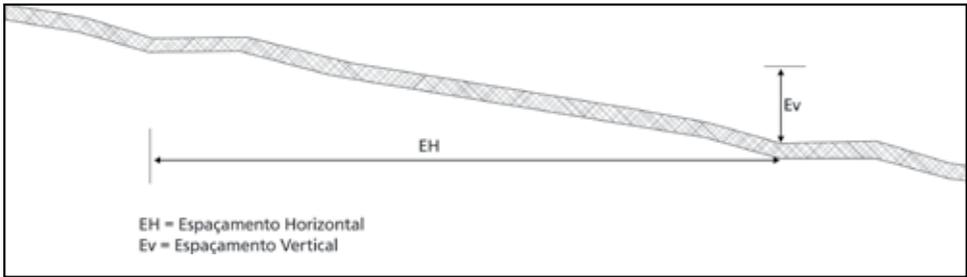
Espaçamento Horizontal e Vertical entre dois Terraços Consecutivos
